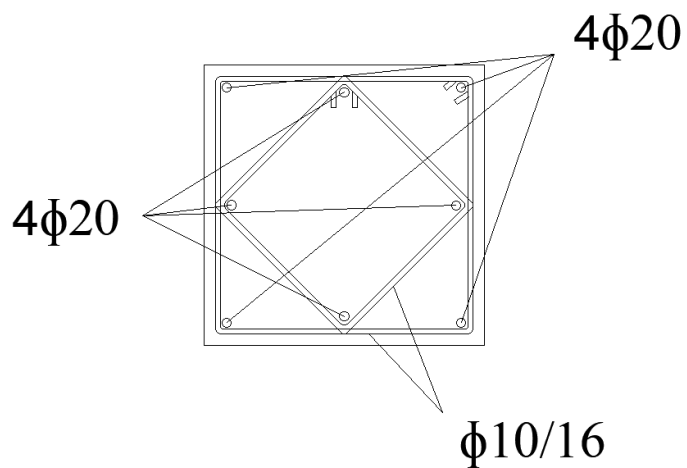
Prikaz plana dimenzionirane armature stupova
